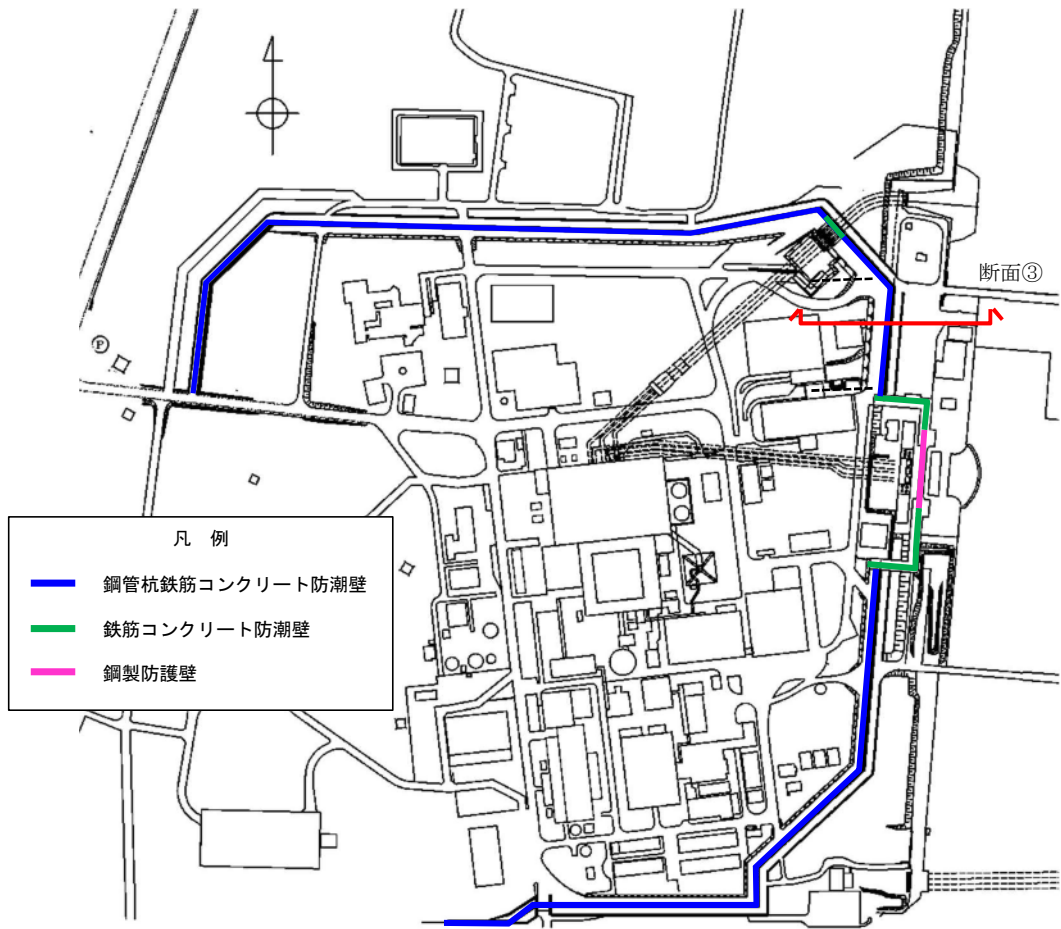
鋼管杭鉄筋コンクリート防潮壁及び評価断面の位置
